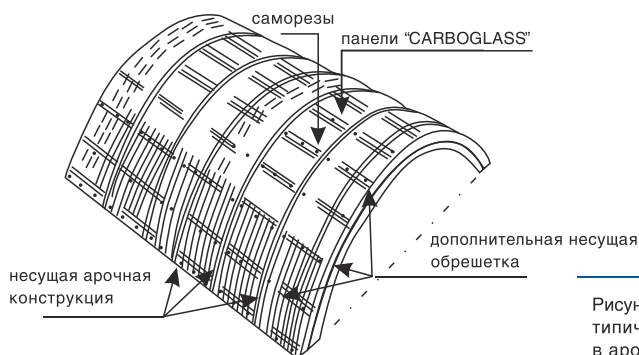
Схематическое изображение типичного способа «обшивки кровли» в арочной конструкции.
